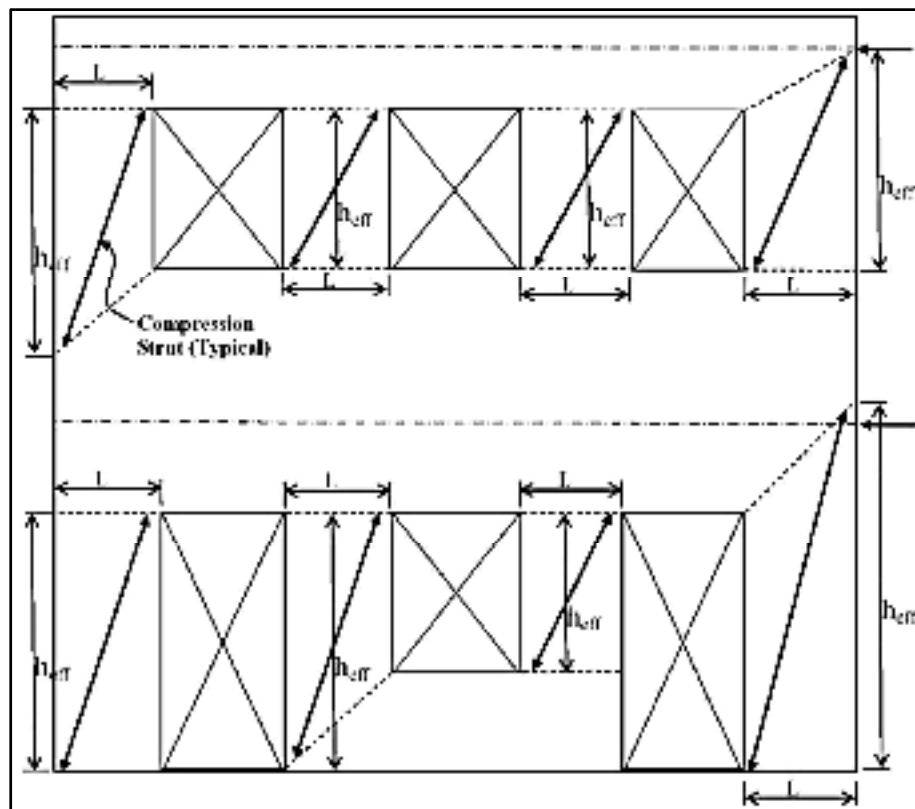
Hauteurs effectives des sections d'un mur en MNA
